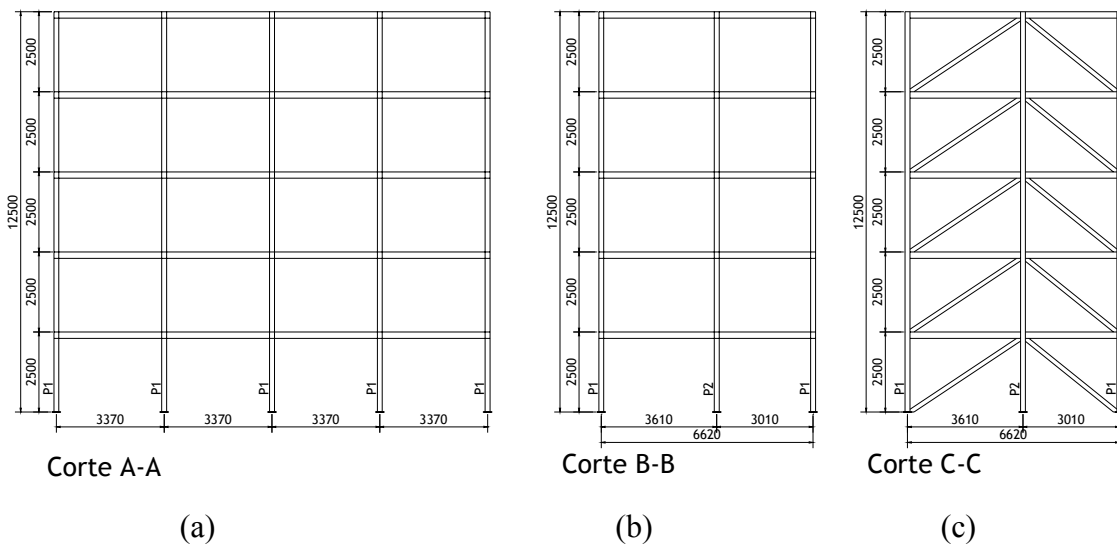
Pórticos do edifício: (a) pórtico rígido no plano yz; (b) pórtico flexível no plano xz; (c) pórtico contraventado no plano xz (medidas em mm).
